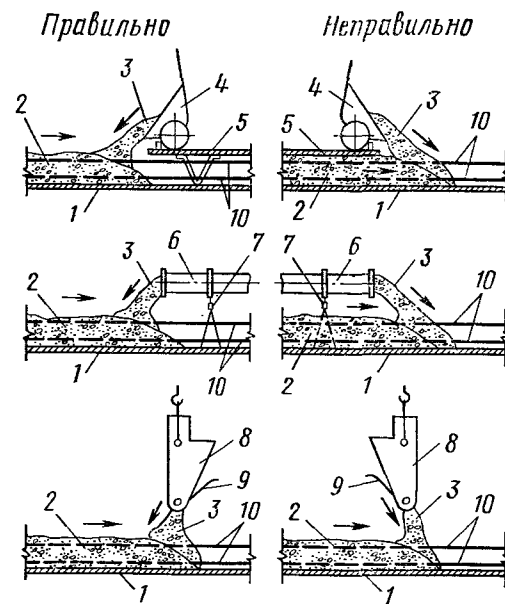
Подача бетонной смеси при бетонировании плит:
